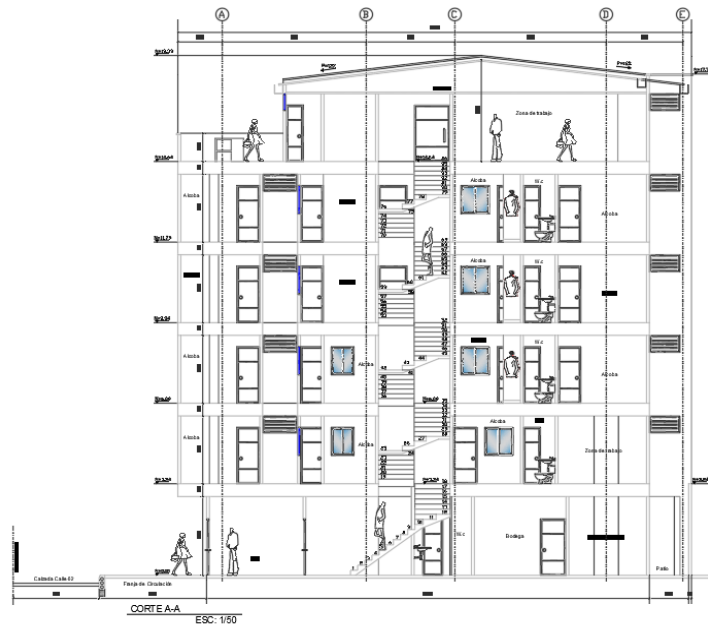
Detalle del plano estructural elaborado en AutoCAD para el proyecto La Universidad – Faustino.
